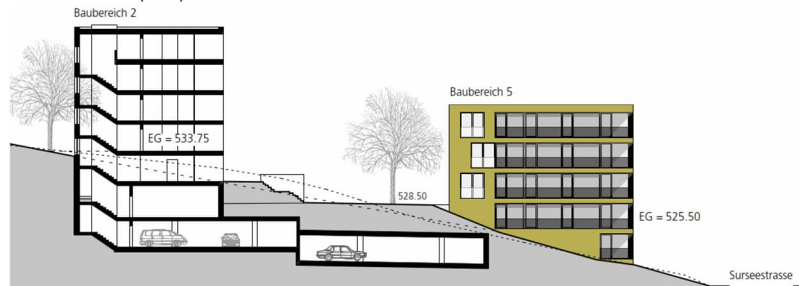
Schnitt B-B gem. Gestaltungsplan Sonnenblick II, 2016
